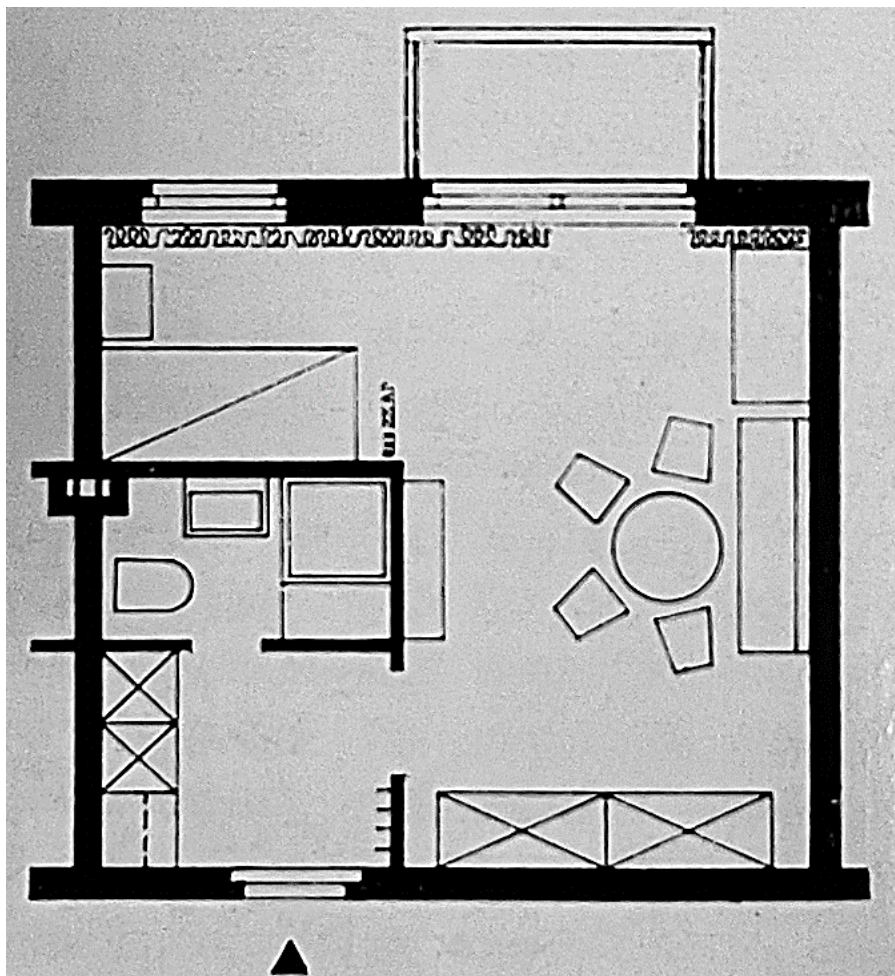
Edith Lassmann, Haus Sonnenhof, Grundriss Einzelzimmer, 1963, Wien.
